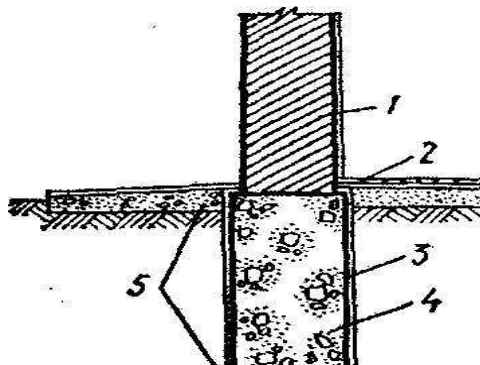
Захист бутобетонних фундаментів: 1 – стіна, оздоблена кислотостійкою плиткою; 2 – кислотостійка підлога; 3 – покриття бітумом; 4 – бутобетон; 5 – кислотостійкий бутобетон
